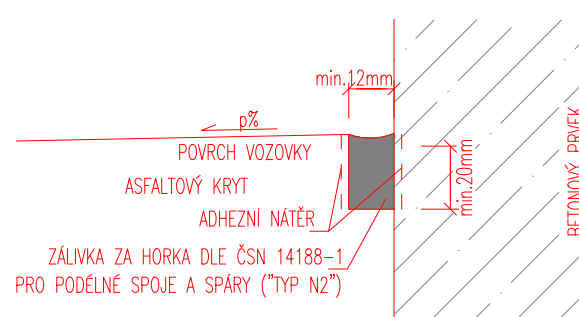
DETAIL ULOŽENÍ NÁJEZDOVÉ BETONOVÉ OBRUBY BO 100/15/15
